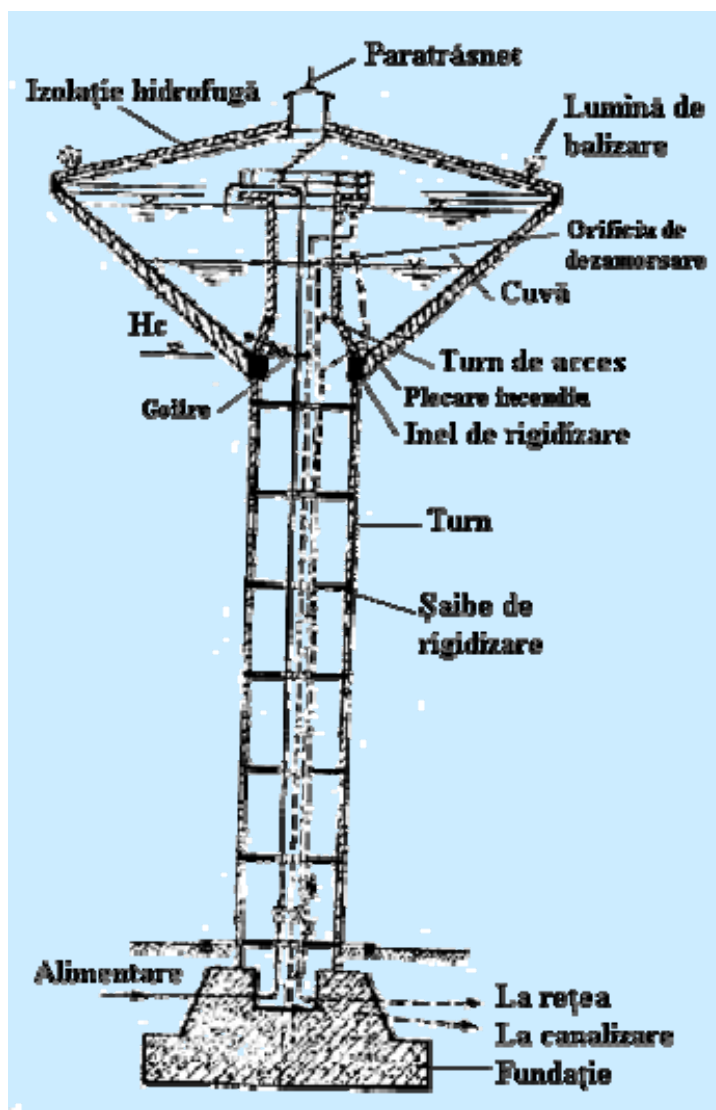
Secțiune transversală printr-un castel de apă cu amplasarea instalației hidraulice
